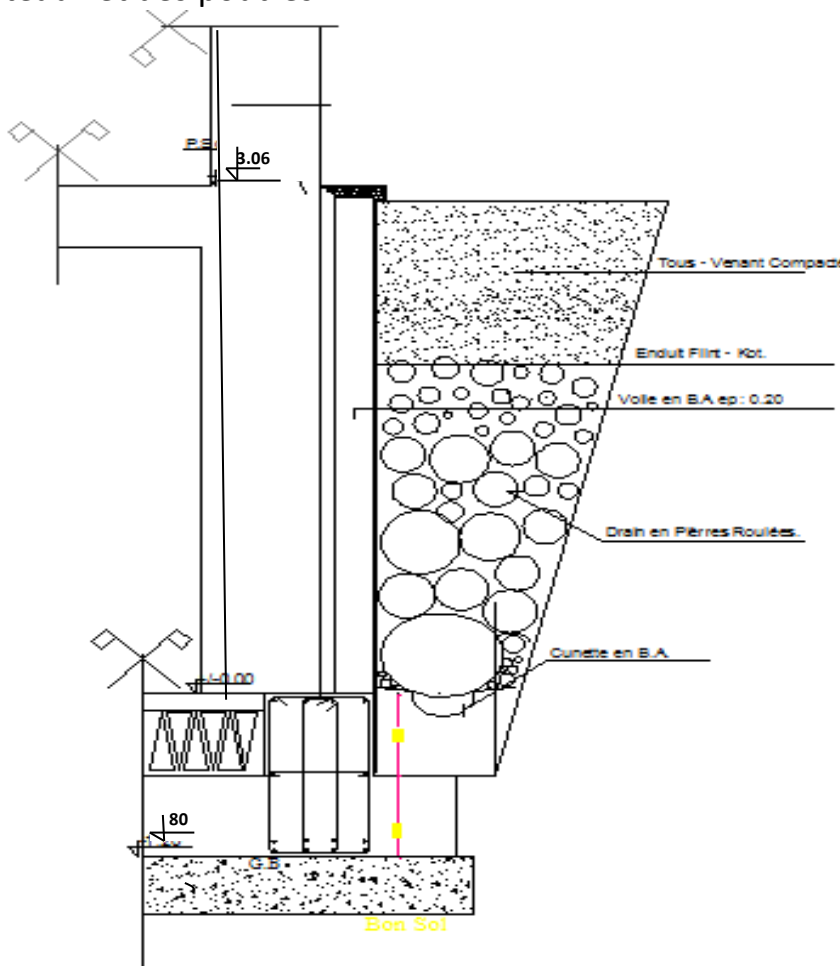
Schéma du mur plaque (Vue en élévation)
